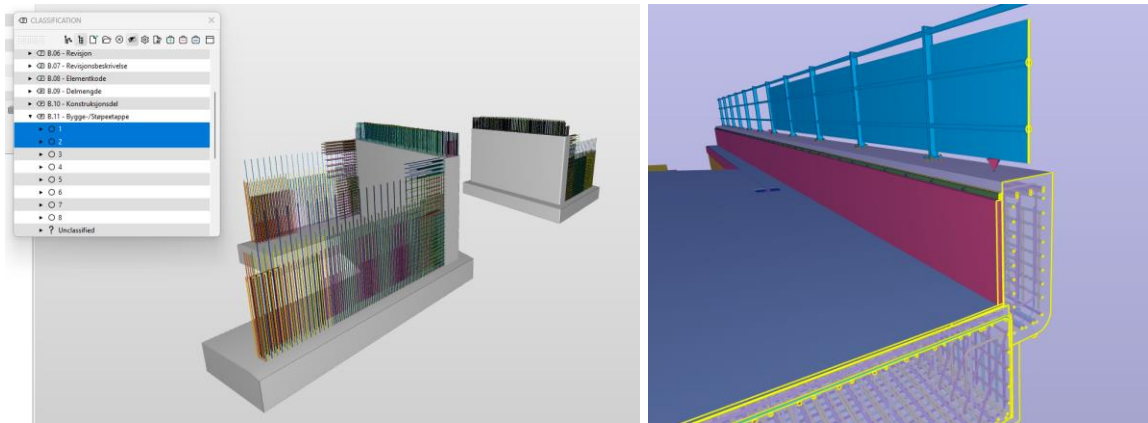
Ponte Karl-Johan – Fases de betonagem do encontro e pormenor das camadas de impermeabilização.
